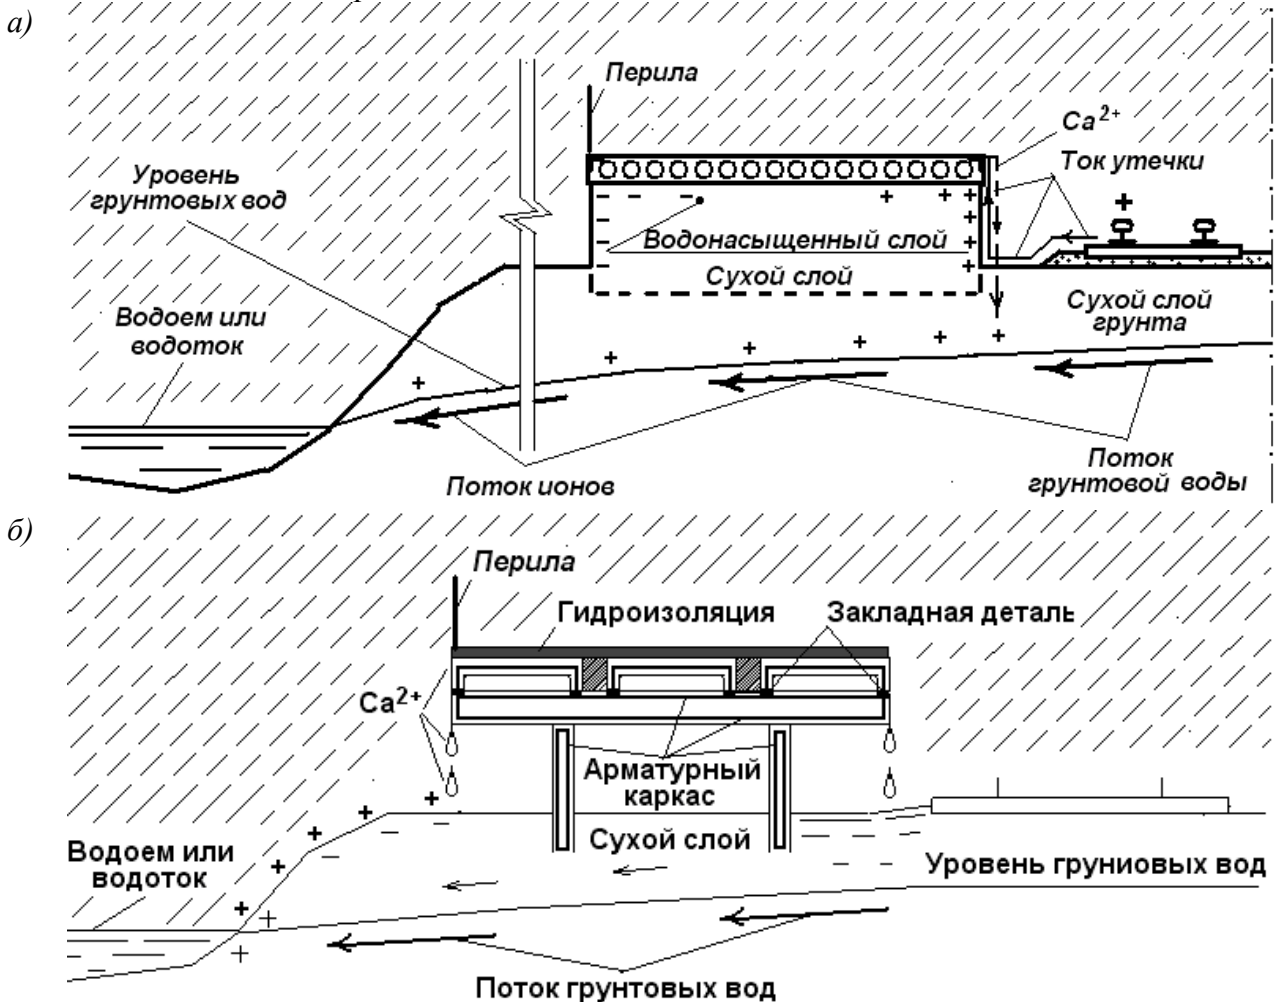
Схема протекания тока утечки с рельсов в конструкции высокой пассажирской платформы: а) с бетонными опорами; б) с железобетонными стойками и ригелями
